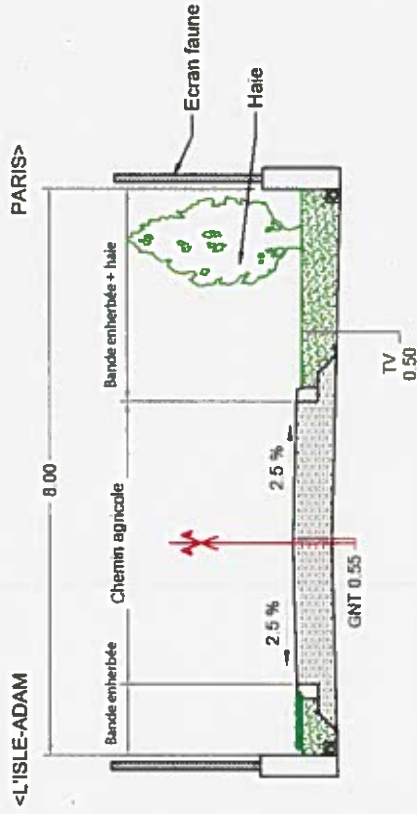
Schéma du passage mixte pour la faune à l'ouest du Bois Carreau © sebec
